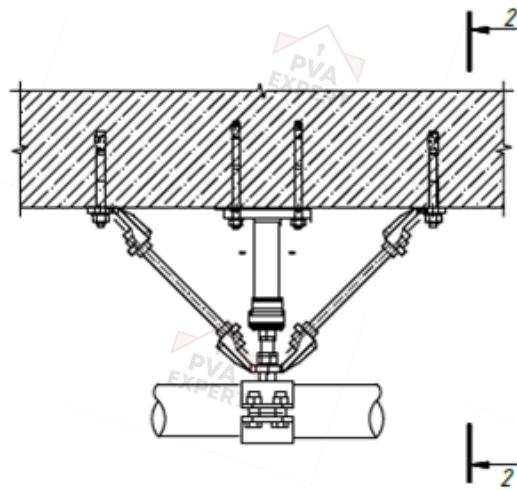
Неподвижная опора в железобетонной стене или перекрытии
